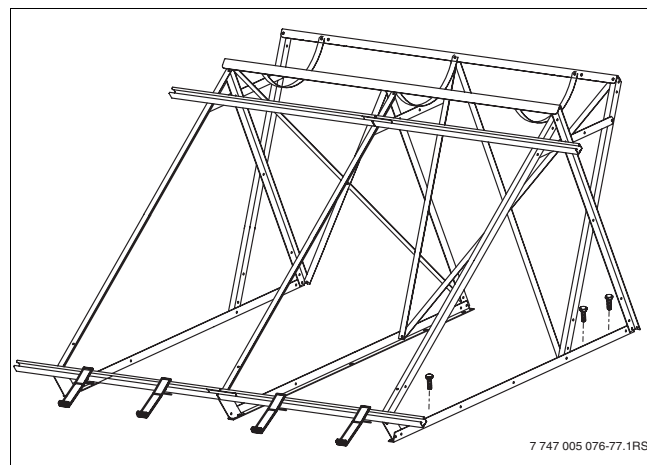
Ligação de telhado no sistema de telhados planos (aqui, no sistema de 300 l)
